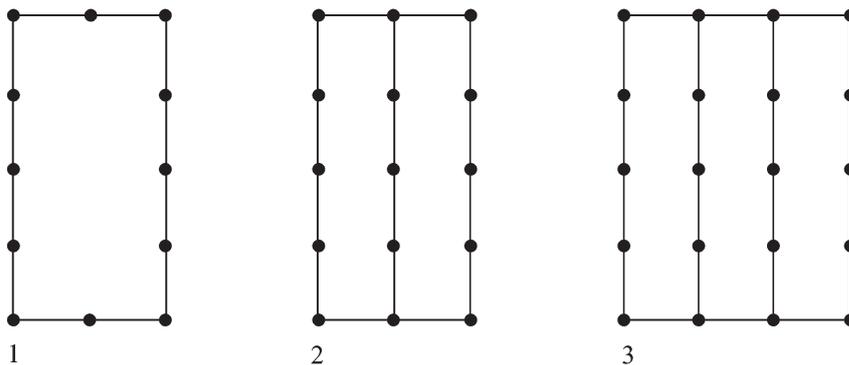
Schematische Aufsicht. 1: einschiffiger Grundriss, 2: zweischiffiger Grundriss, 3: dreischiffiger Grundriss.
